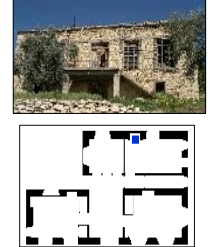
(a) Yapı 2 ve bahçesi (Building 2 and its garden), (b) Yapı 4 ve bahçesi (Building 4 and its garden)
